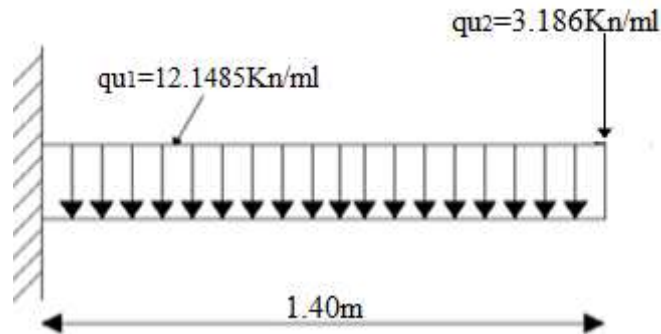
Schéma statique de la dalle plane à l'ELU.
